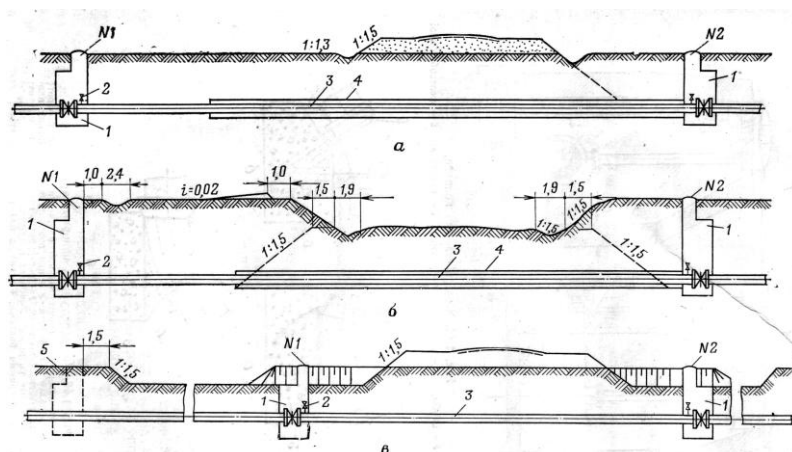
Переходы трубопроводов под автомобильными дорогами:
